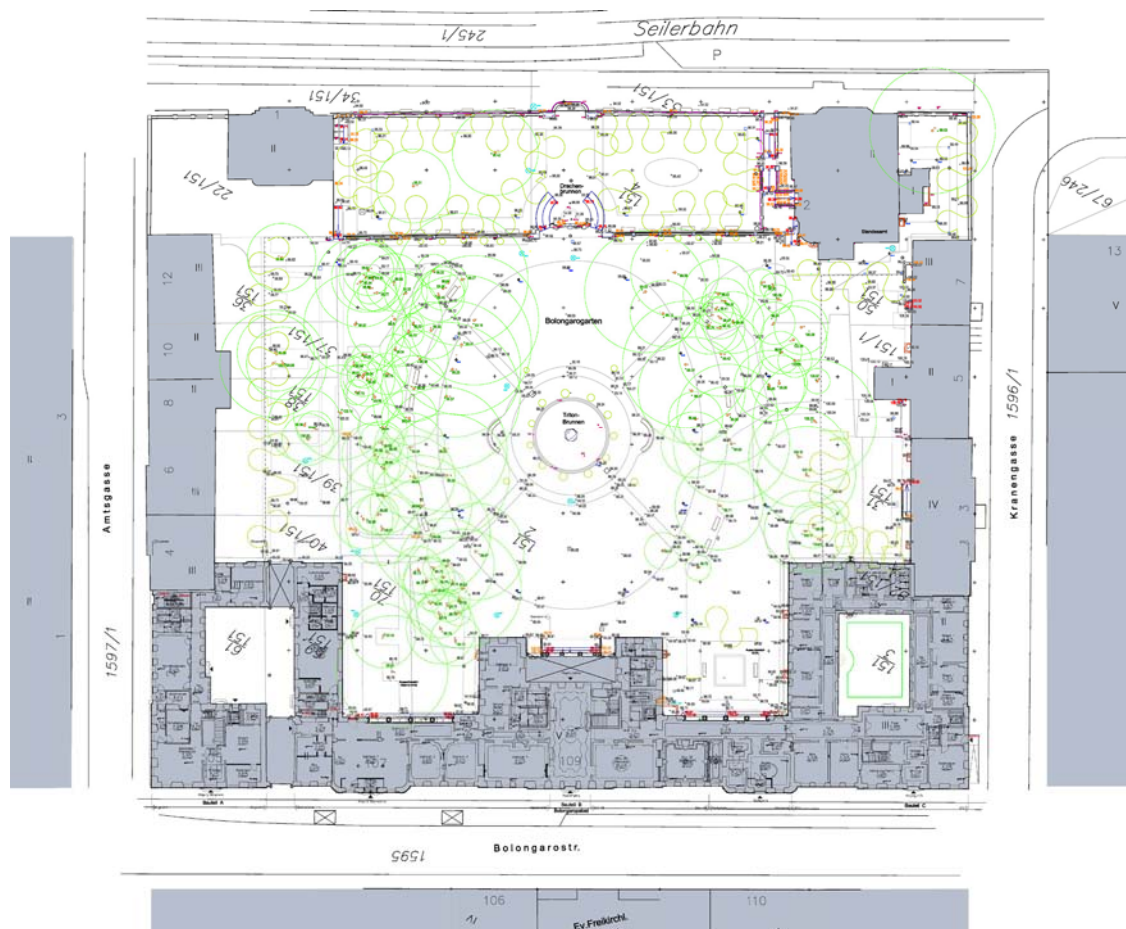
Plan Baumbestand, Quelle Grünflächenamt
